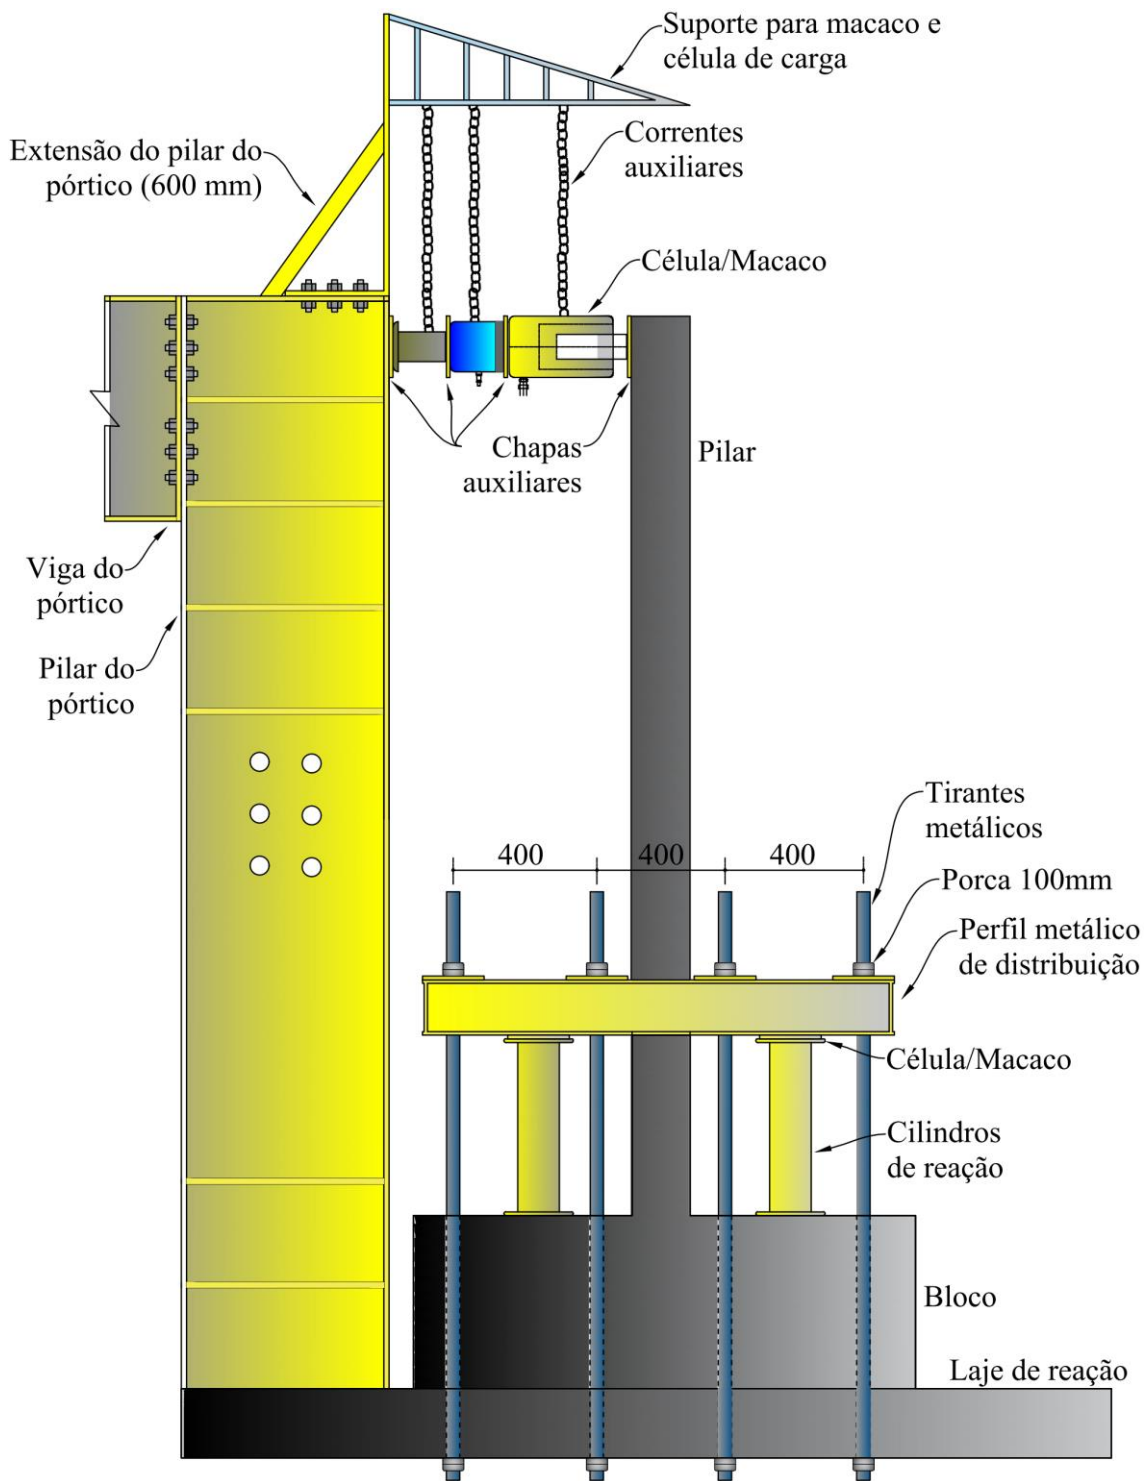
Sistema de ensaio do pilar P3 (Fonte: Autor)
